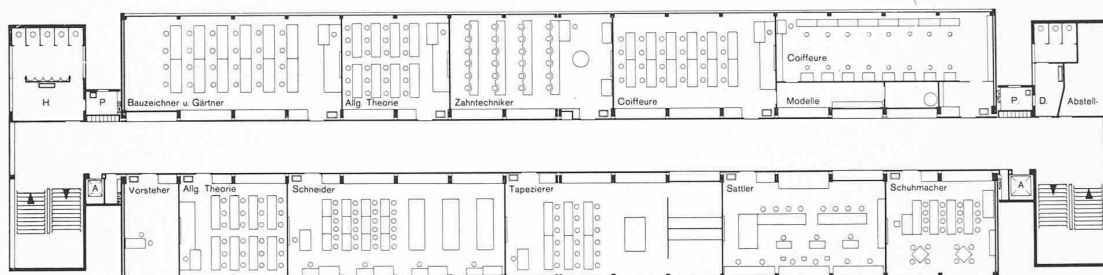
Grundriss eines normalen Schulgeschosses (3. Obergeschoss), Masstab 1:500
